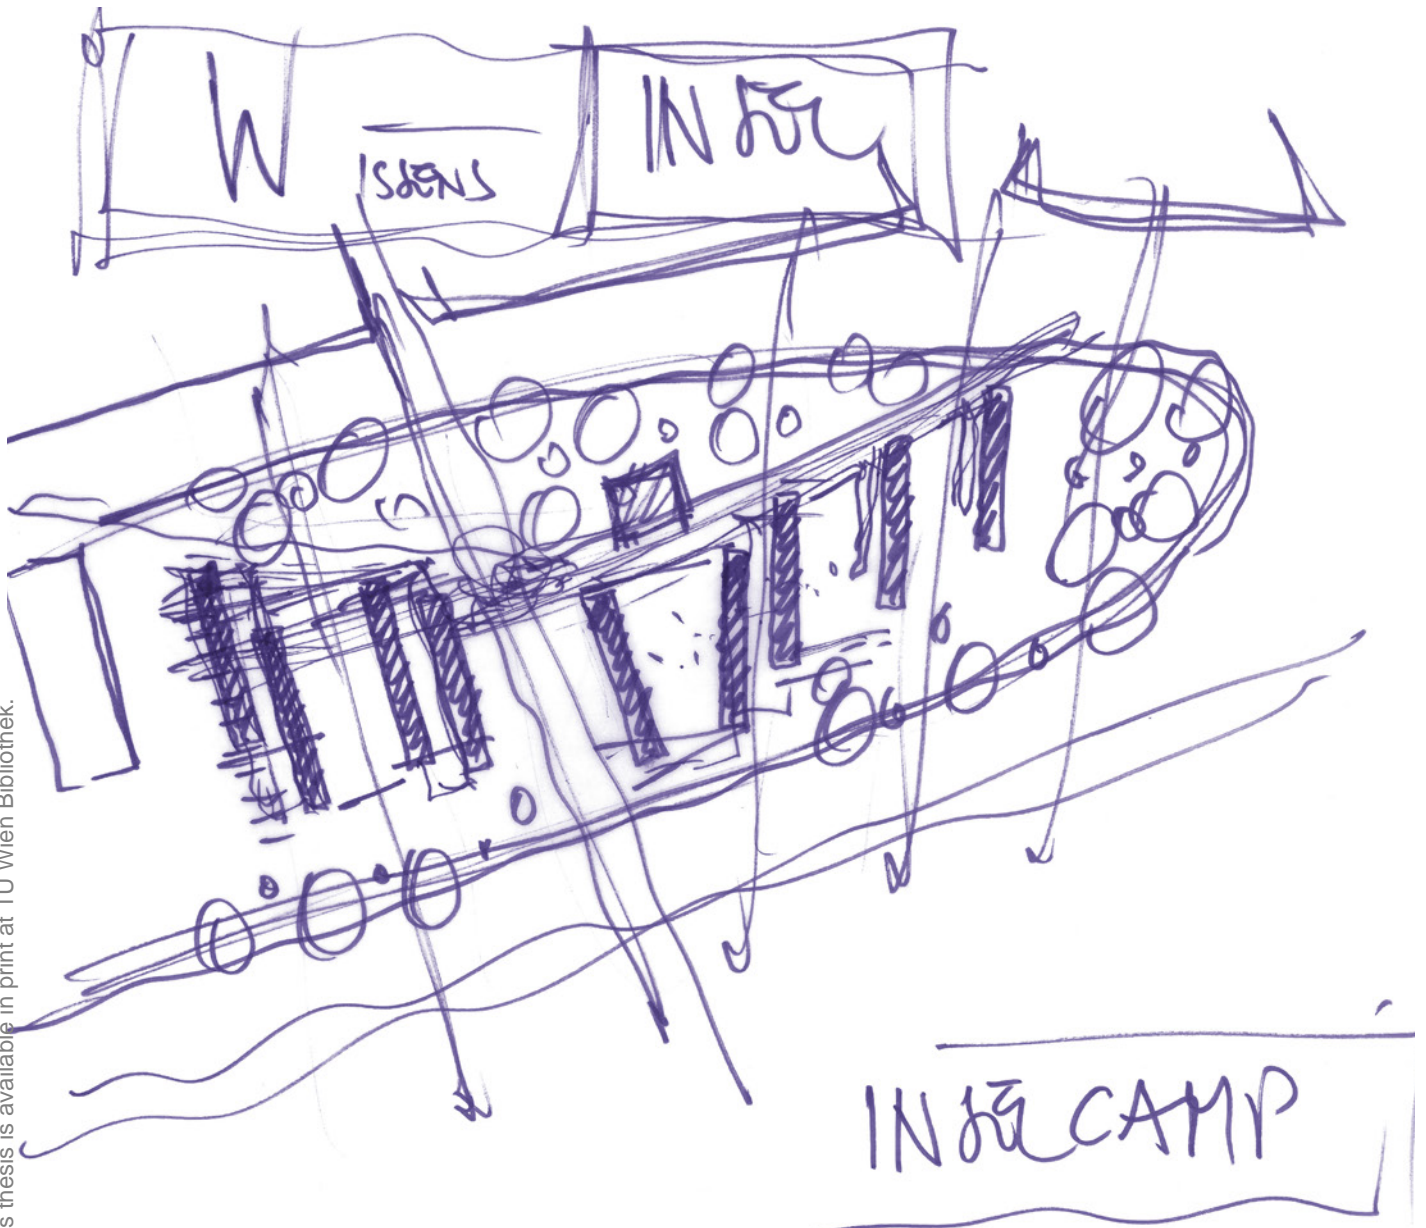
Workshop 01 - Brainstorming Grundrissgruppe
